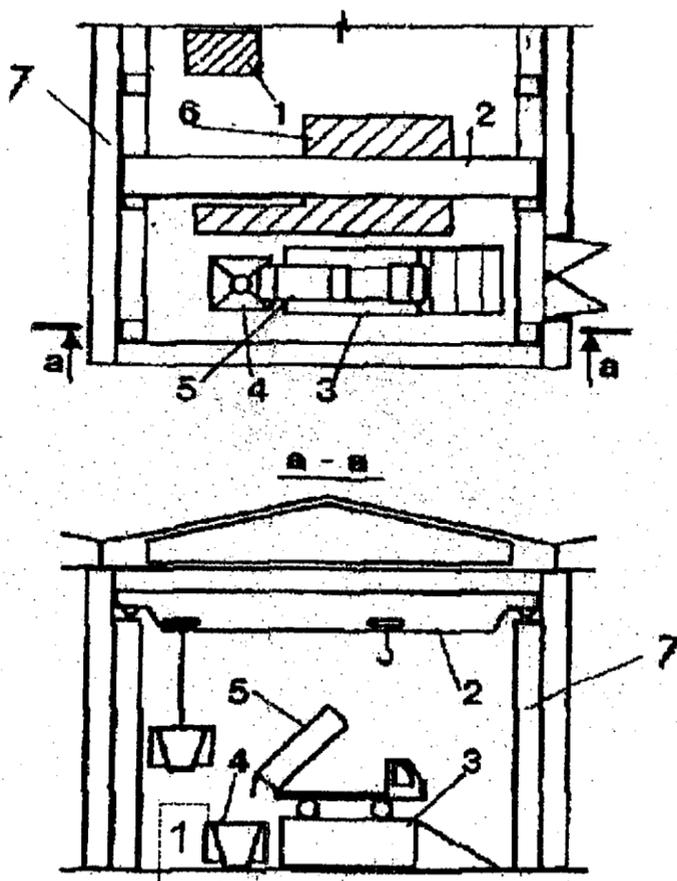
Схема подачи бетонной смеси с помощью мостового крана (в промышленном здании);
